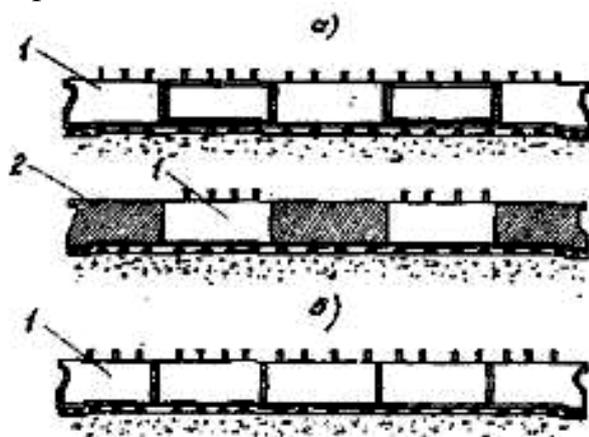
Бетонирование конструкций: а/ - через один блок; б/ - последовательное; 1 - свежеложенный бетон; 2 - затвердевший бетон
